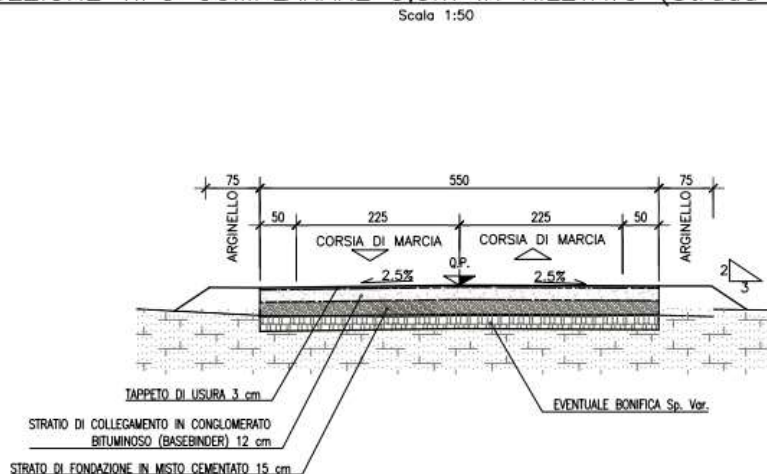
Sezione tipo complanare 5,5 m in rilevato
